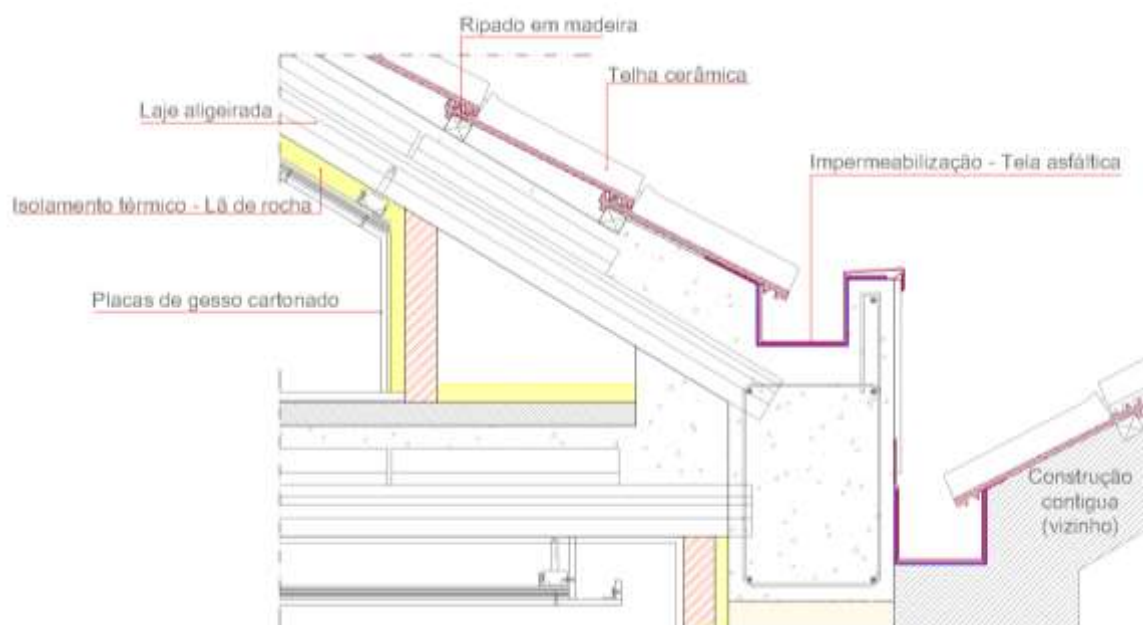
Pormenor construtivo da cobertura inclinada revestida a telha cerâmica (P2)
